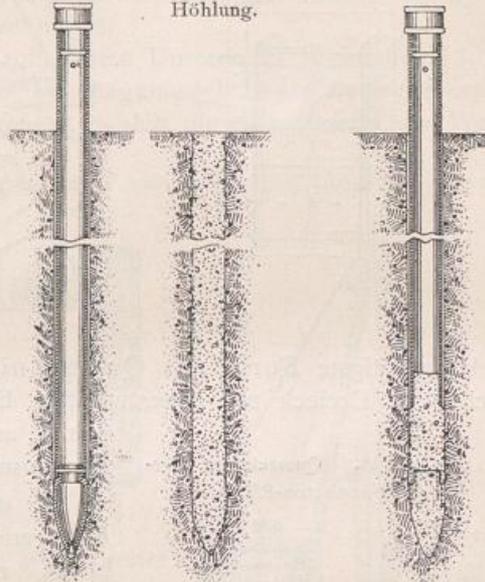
Herstellung eines Beton-Stampfpfahls in weichem Boden.
